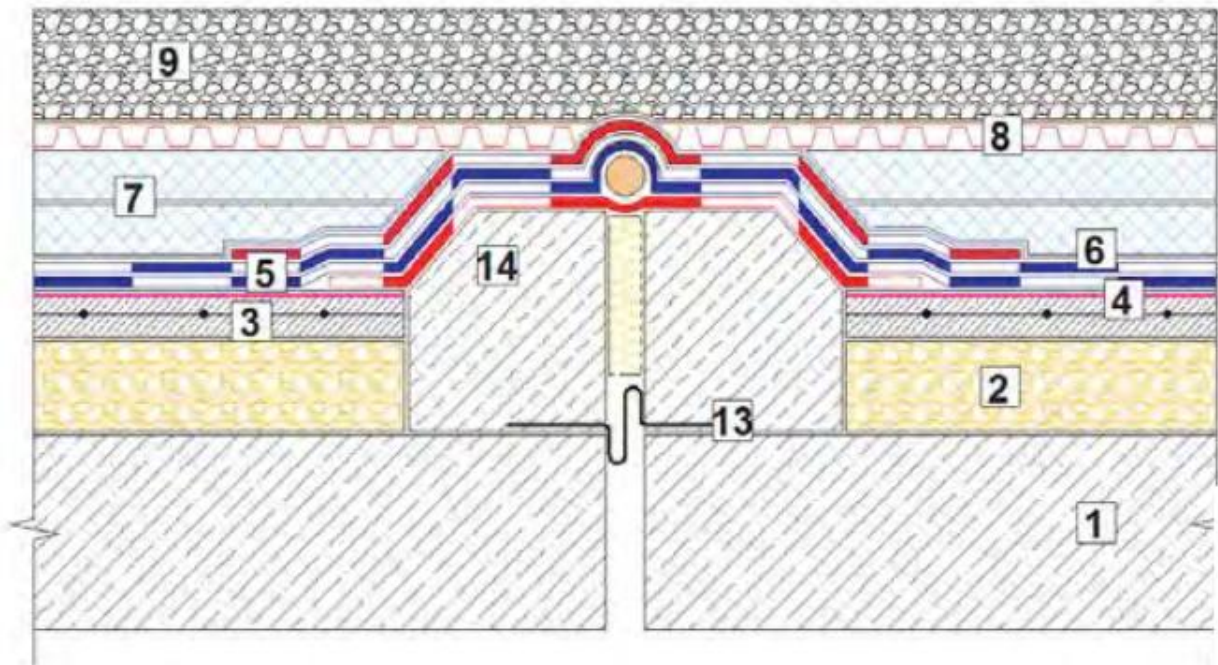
Деформаційний шов, де: 1 – з/б плита перекриття; 2 – схилоутворюючий шар із керамзитового гравію; 3 – армована цементно-пісчана стяжка; 4 – праймер бітумний; 5 – гідроізоляційний шар; 6 – голкопробивний геотекстиль 300 г/м<sup>2</sup>; 7 – екструзійний пінополістирол щільністю 35 кг/м<sup>3</sup>; 8 – дренажна мембрана; 9 – баласт; 13 – металевий компенсатор; 14 – кладка.
